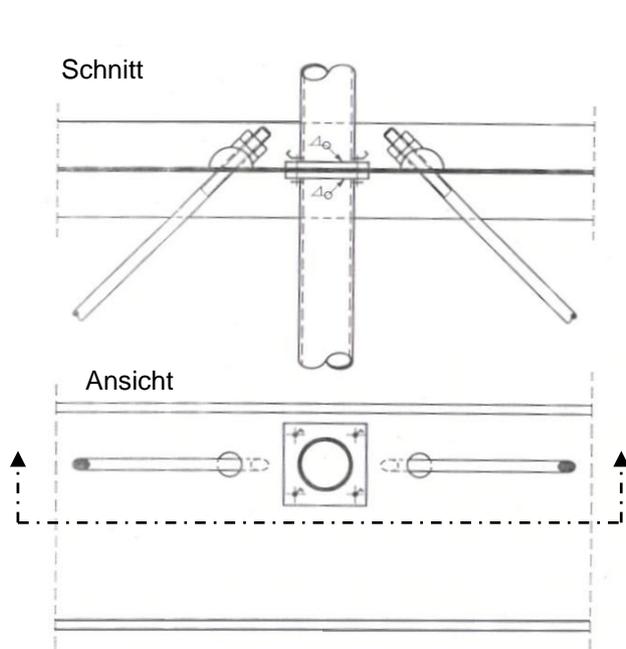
Dachverband mit Pfosten aus Rohrprofilen und Diagonalen aus Rundstählen Mit Formstückanschlüssen [12]
